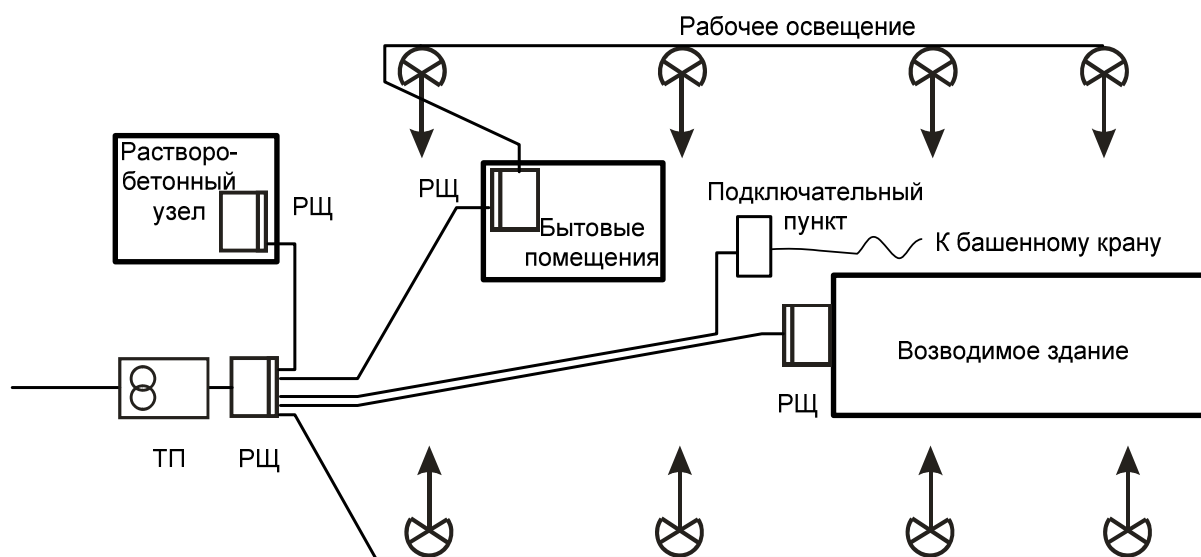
Комбинированная схема электроснабжения строительной площадки:
